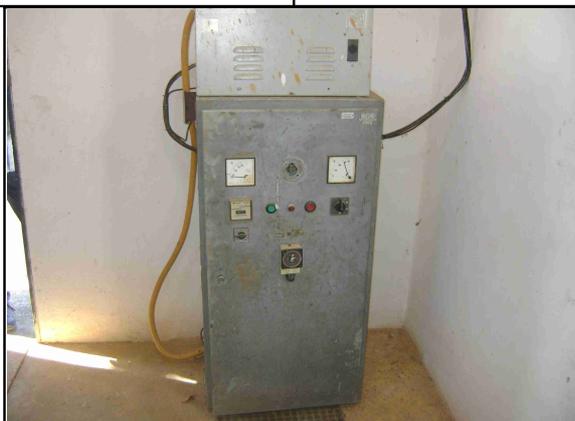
Quadro de comando do PT-02 apoiado diretamente no solo e em más condições de conservação.
